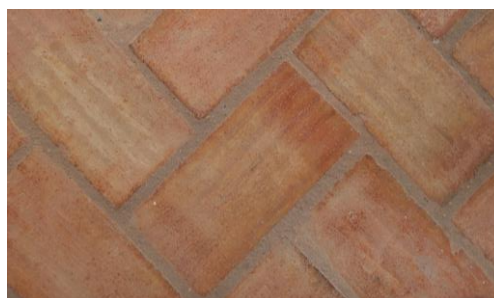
Pavimento existente em terracota_exterior. Fonte: Atelier Studio Arte
